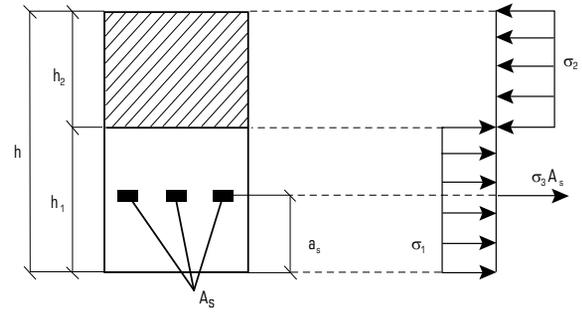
Схема к расчету армированного сечения по методу предельного равновесия: h_1 — высота растянутой зоны, м; h_2 — высота сжатой зоны, м; a_s — местоположение армирующего элемента от наиболее растянутой грани, м; A_s — площадь поперечного сечения армирующего элемента, м²
